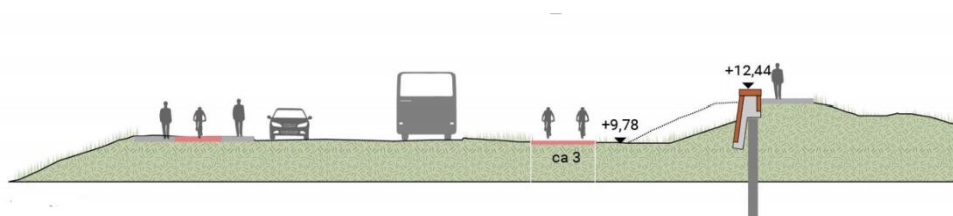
Doornede ontwerp ten noorden van kruising Zoutkeetstraatje - Havendijk
